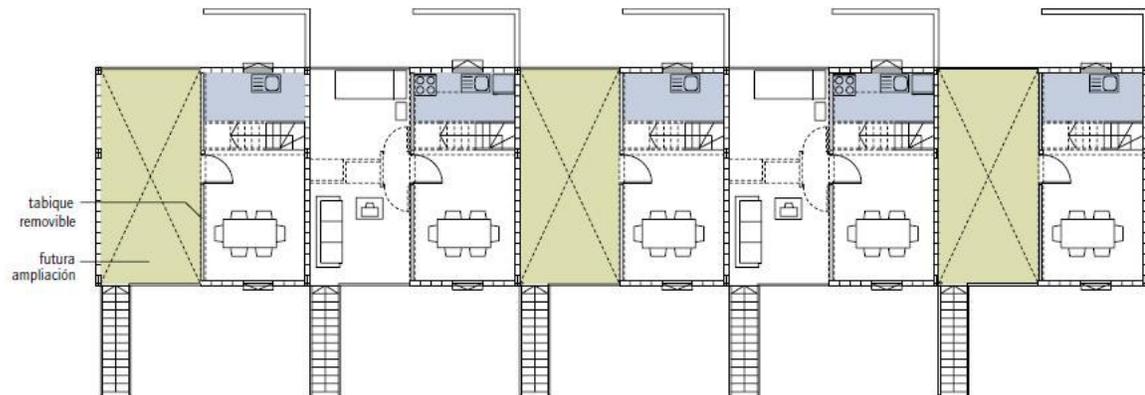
Sala do apartamento duplex (1º pavimento) - acesso
